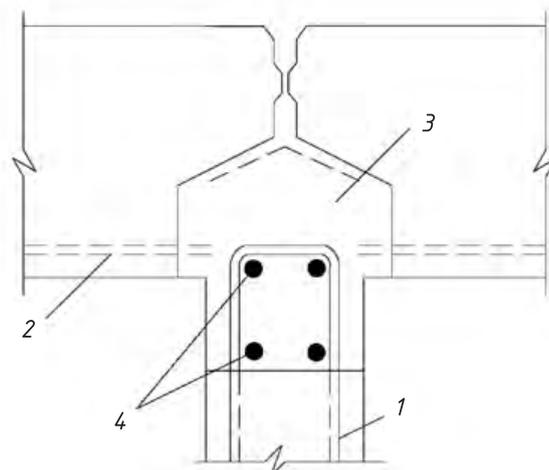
Конструкция связей железобетонная замоноличиваемая: 1 — панель наружной стены; 2 — панель внутренней стены; 3 — бетон замоноличивания; 4 — продольная арматура стыка
